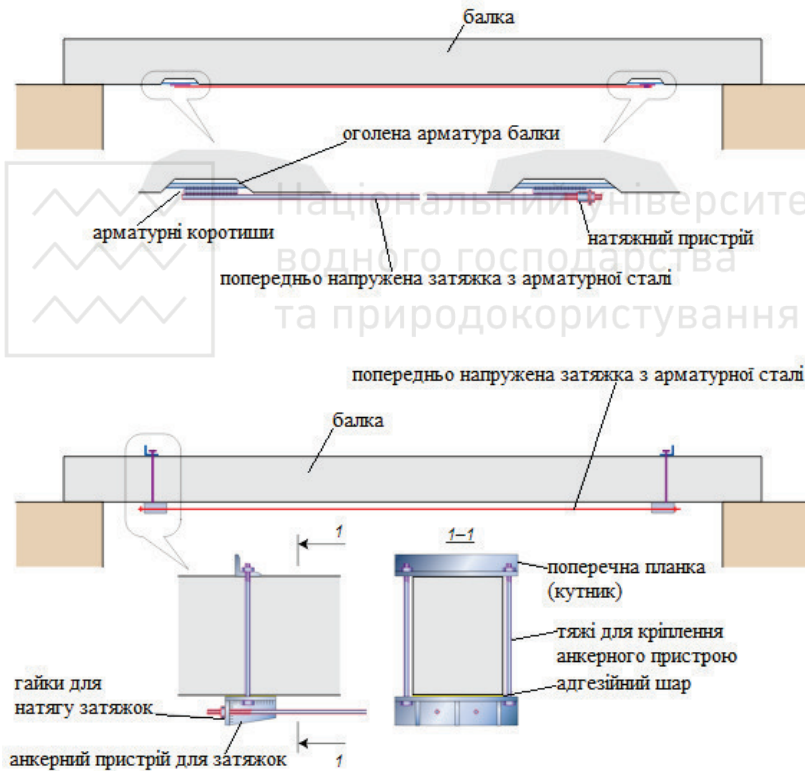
Підсилення залізобетонних балок затяжками з арматурної сталі
